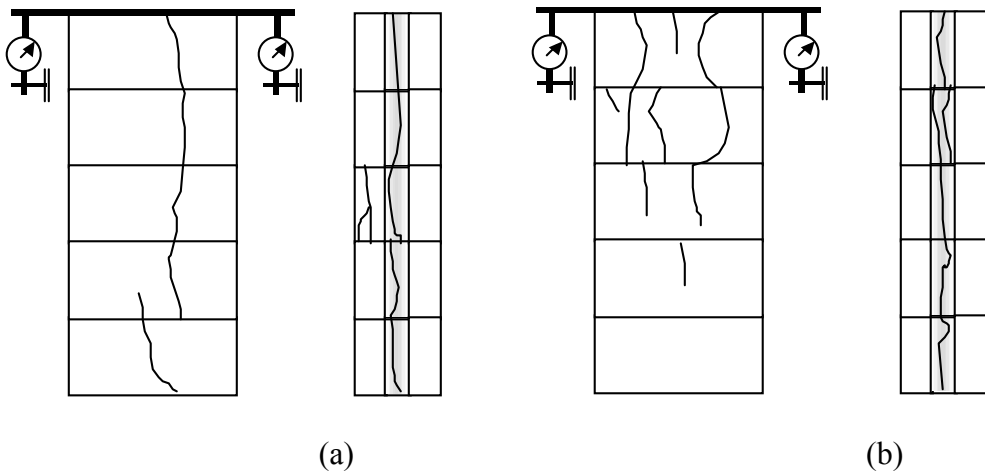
Mapa da fissuração em P3 e 4 de [1x5] – face sul e oeste
